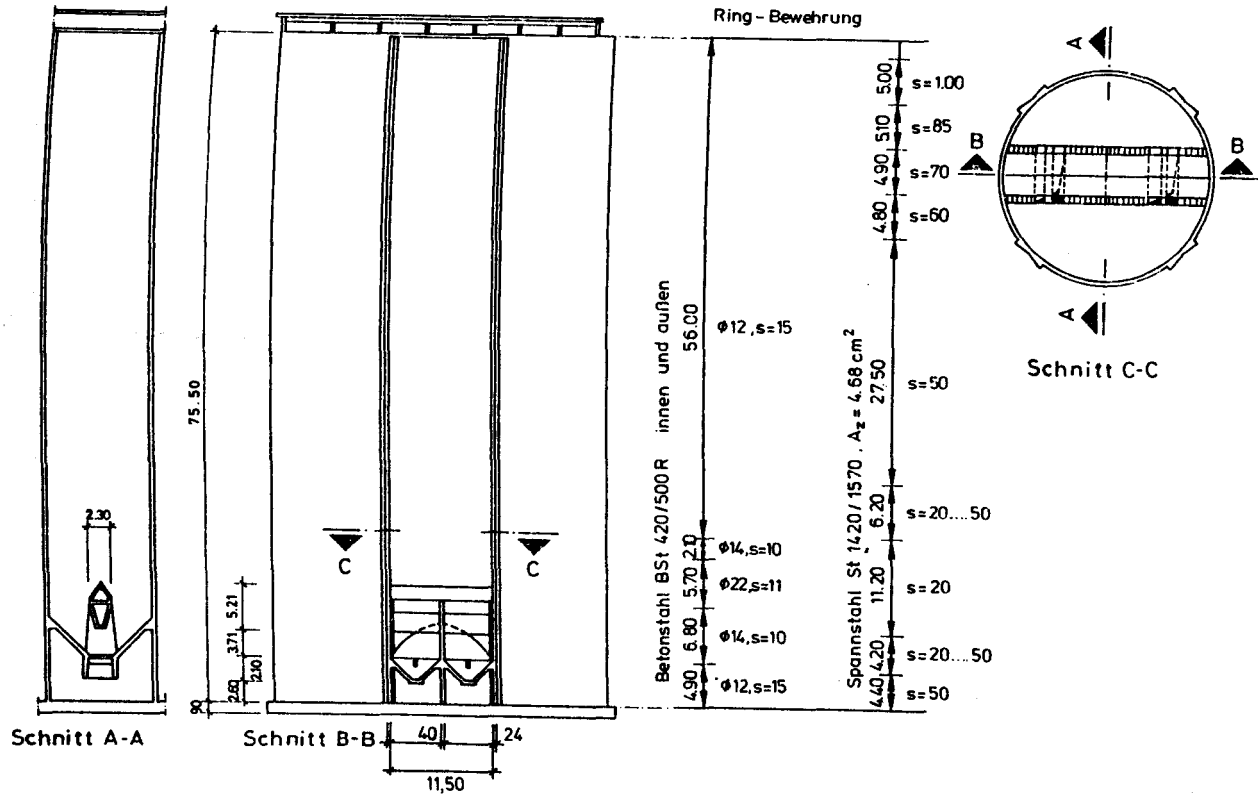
Schnitte und planmäßige Ringbewehrung
